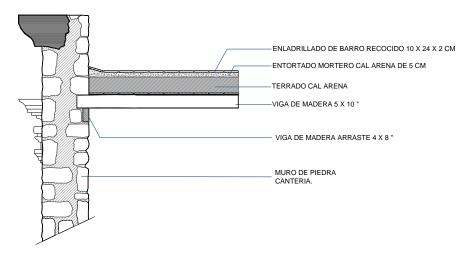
Detalle No. 1 vista del corte de la cubierta mostrando la viguería, el enladrillado y el terrado.
